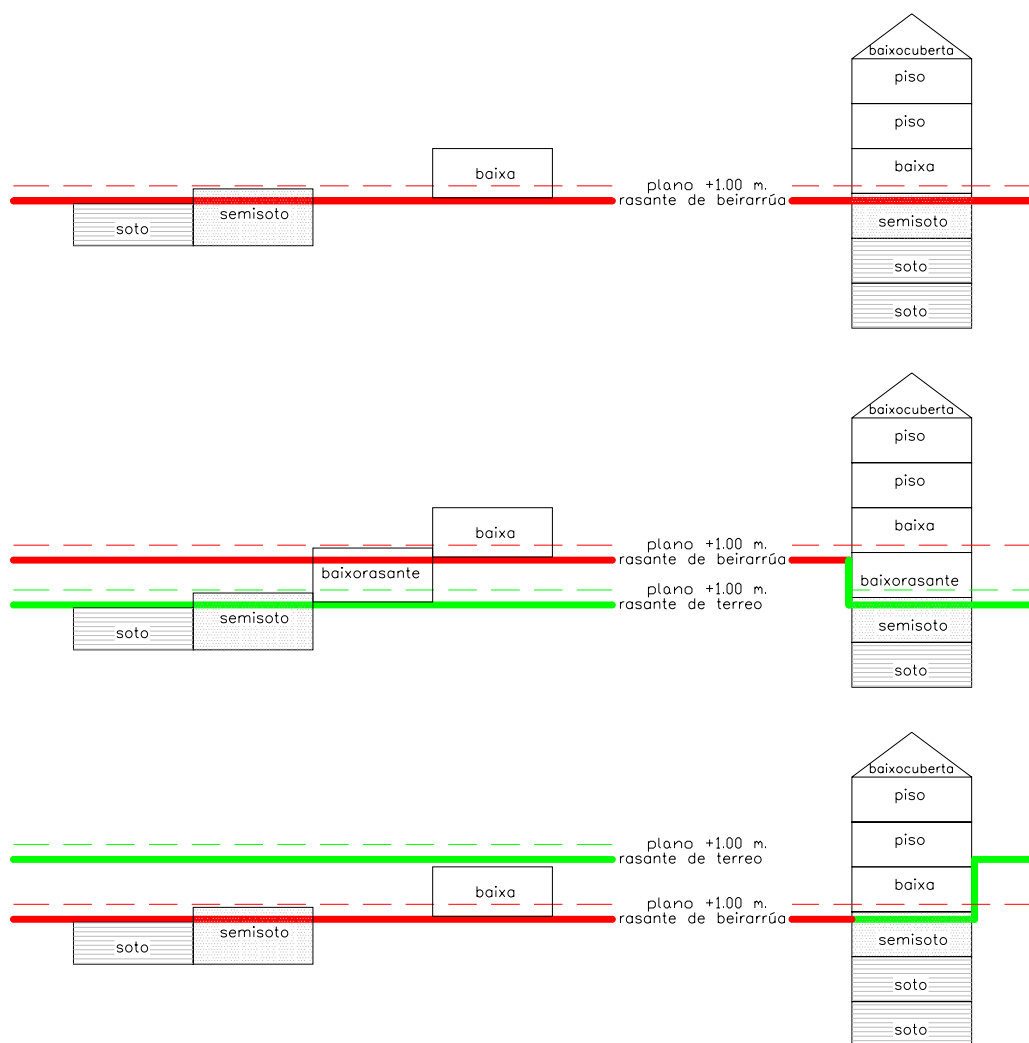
Posición de plantas soto, semisoto, baixorasante e baixa con respecto a rasante de beirarrúa e a rasante do terreo
